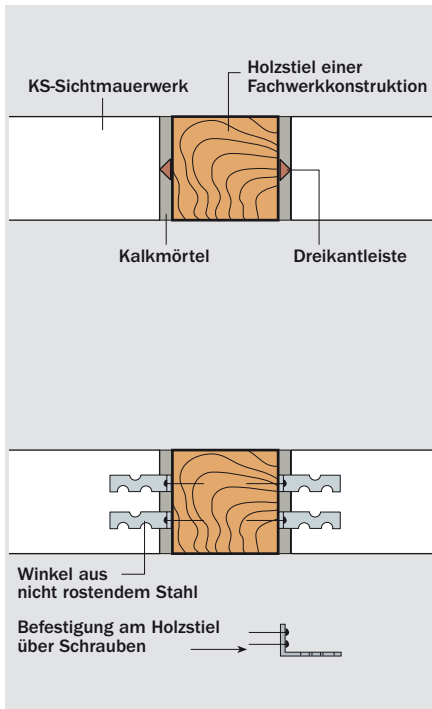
Wandanschluss von KS-Sichtmauerwerk an eine Holzfachwerkkonstruktion
